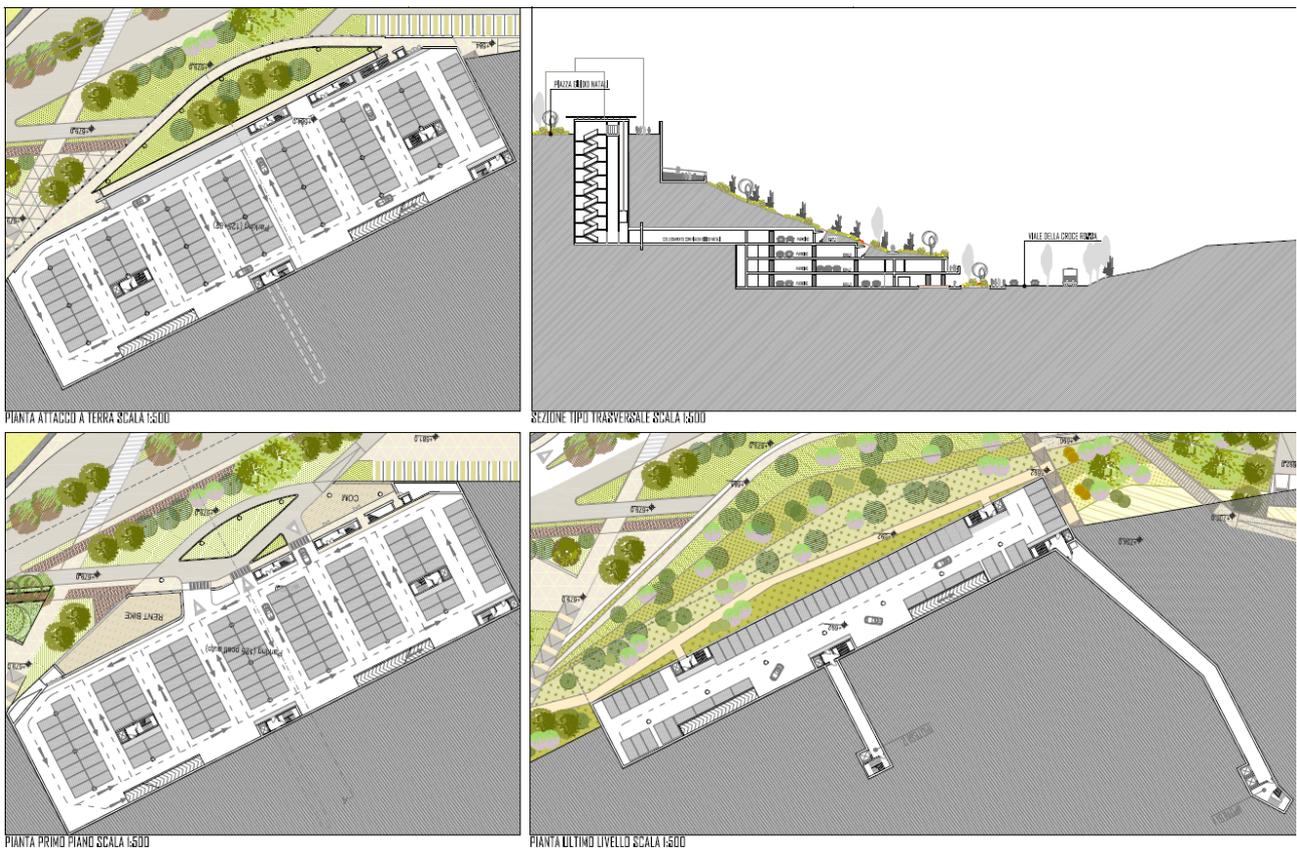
PIANTE DEL PIANO INTERRATO DA PRU APPROVATO CON D.C.C. 108/2016
